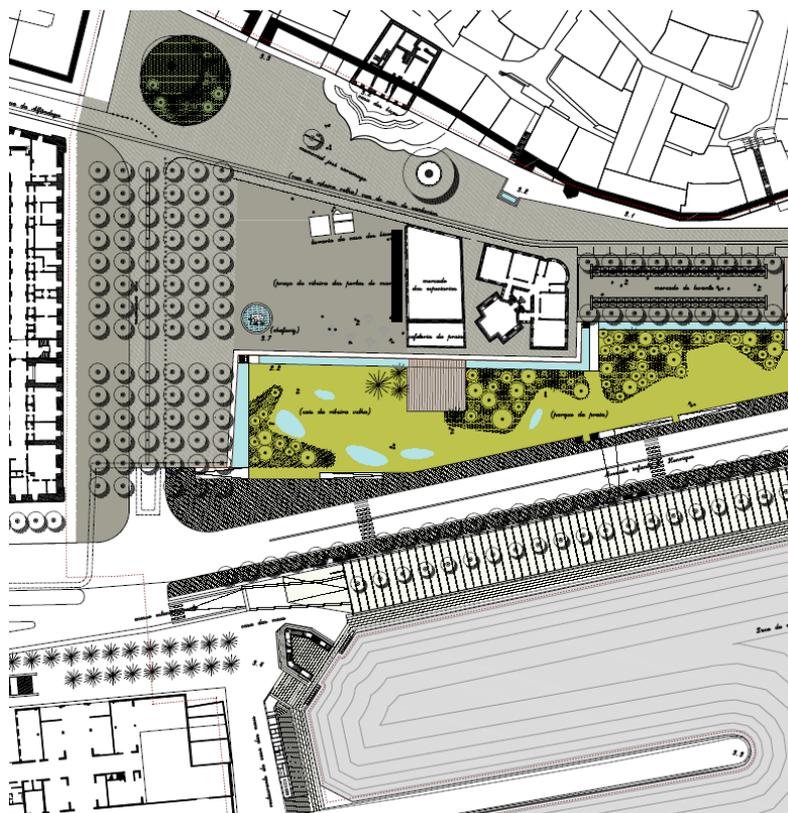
Planta com proposta de projeto (GLOBAL, 2012)
